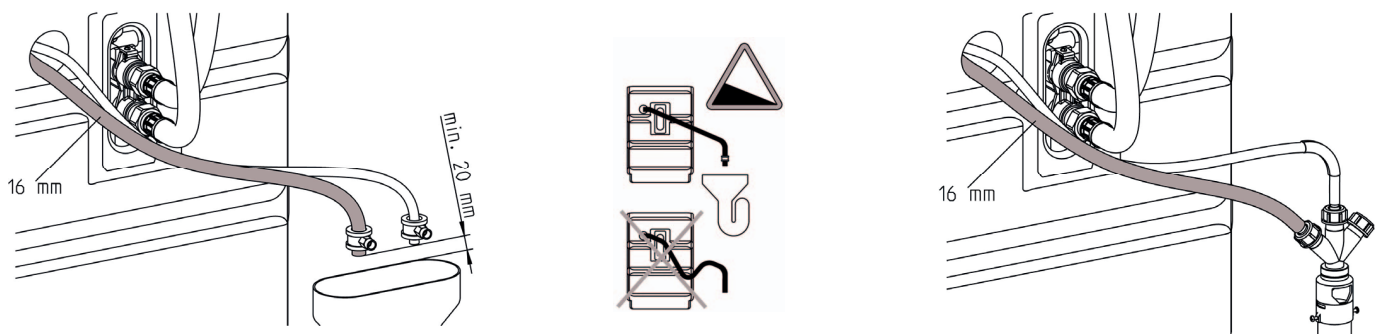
Kanalanschluss Überlaufschlauch Salztank mit und ohne Kanalanschluss DN 50 nach DIN EN 1717 für Kleinenthärungsanlagen (Bestell-Nr. 187 840)
